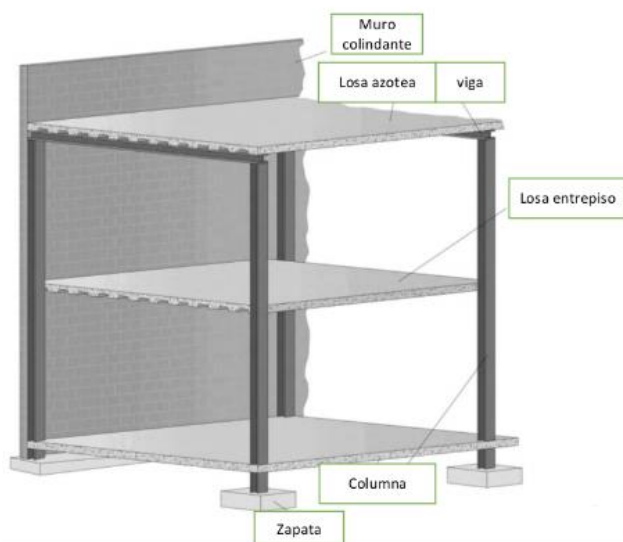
Ejemplos de elementos estructurales. Obtenido de: Earthquakes reducing the risk of nonstructural earthquake damage
